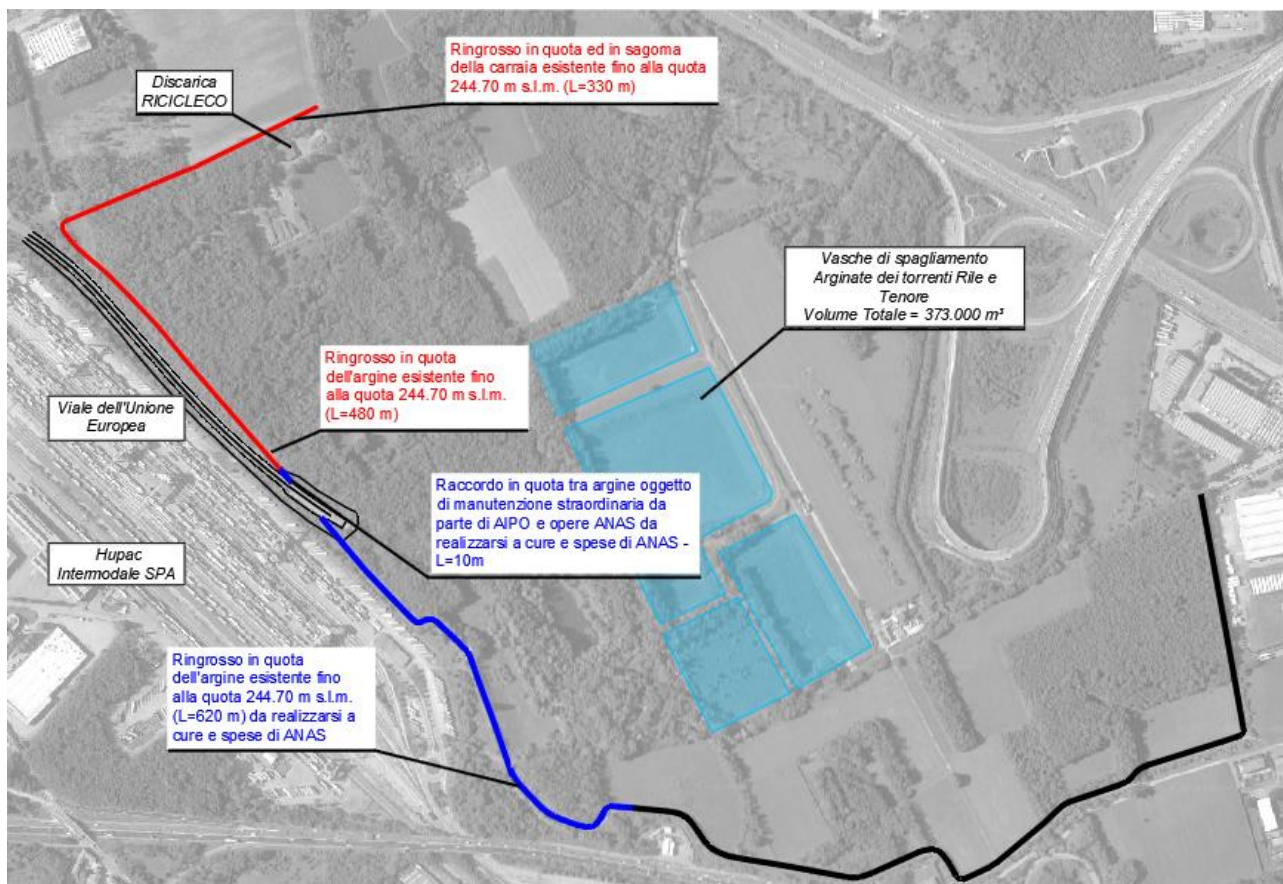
MASTERPLAN DELLE OPERE IN PROGETTO
